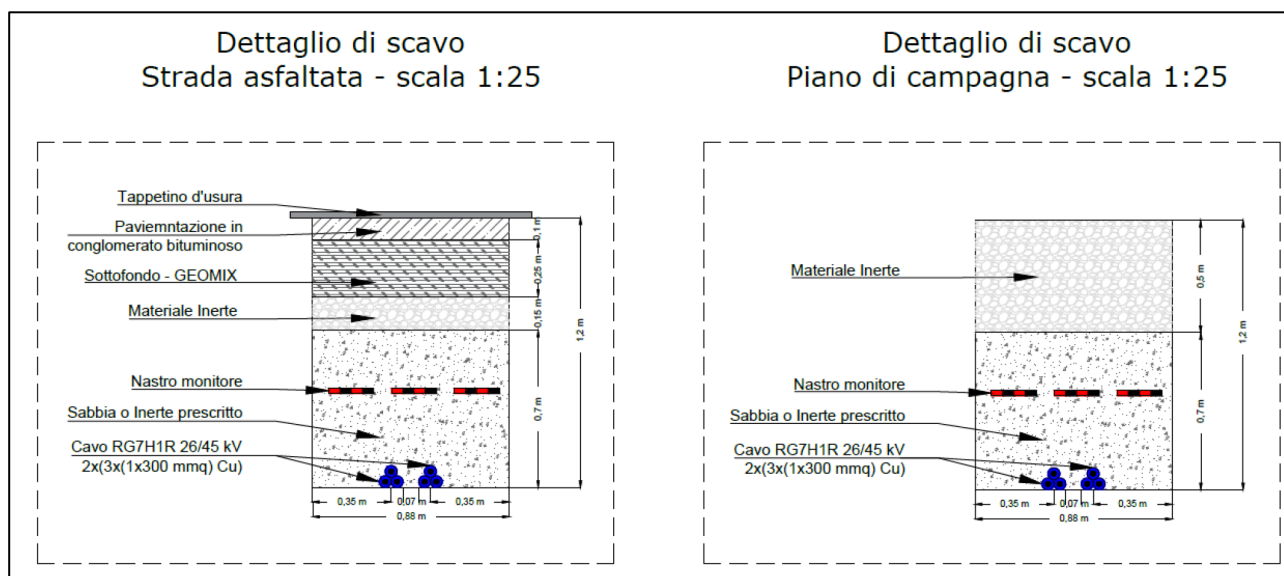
Tipici della sezione di scavo del cavidotto di connessione linea AT
